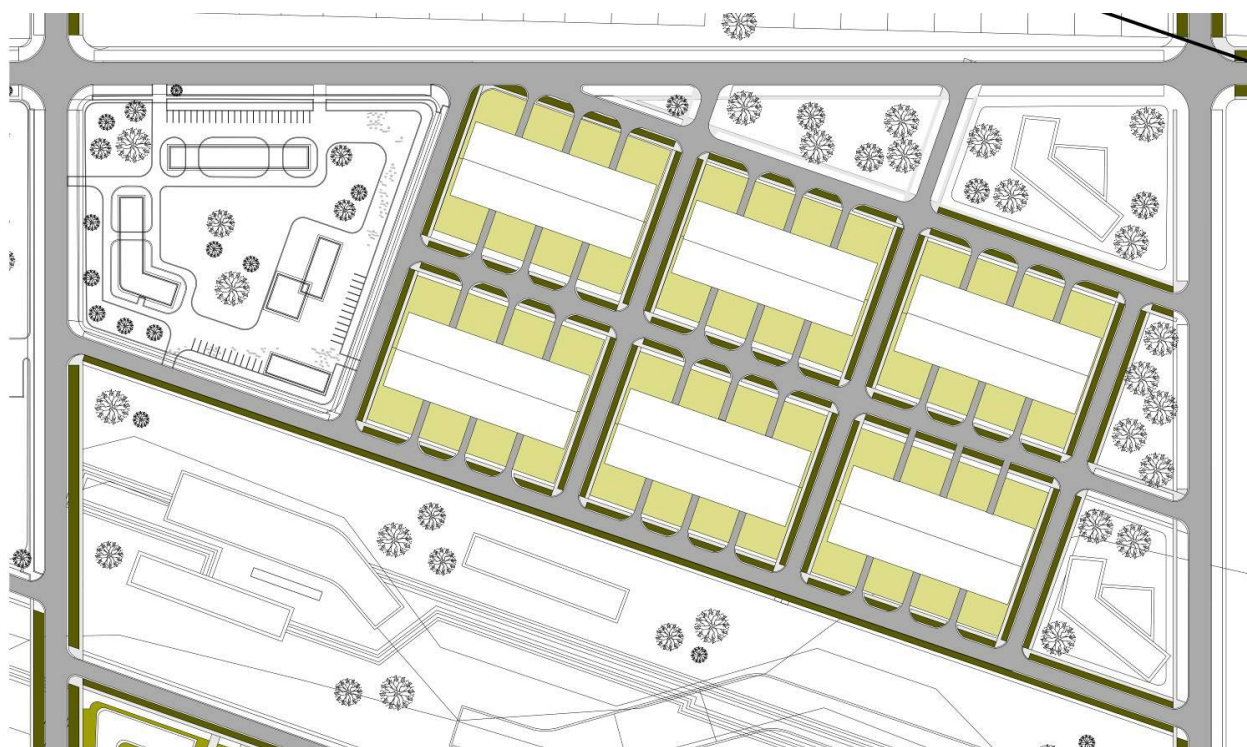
Фрагмент генерального плана с блокированным домом ролл-хаузинг
